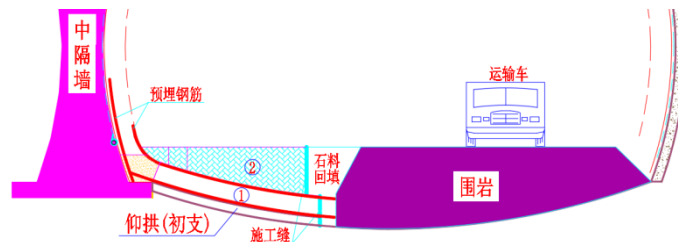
左幅仰拱及第一层仰拱填充施工断面图
